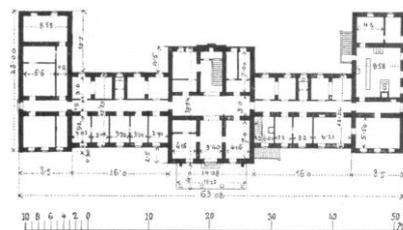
Hotel Toblach, Grundriss EG.
